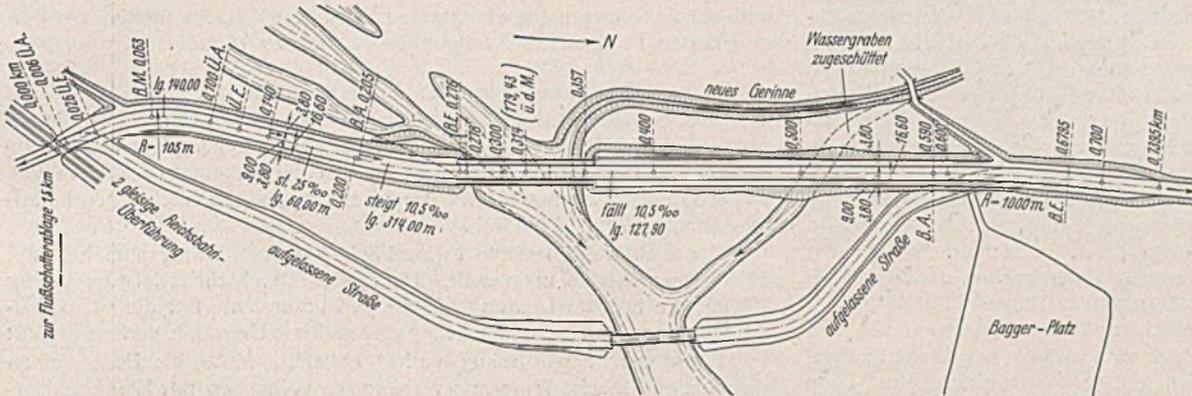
Lageplan der alten und neuen Straße im Anschluß an die Strombrücke mit alter und neuer Flutbrücke.
